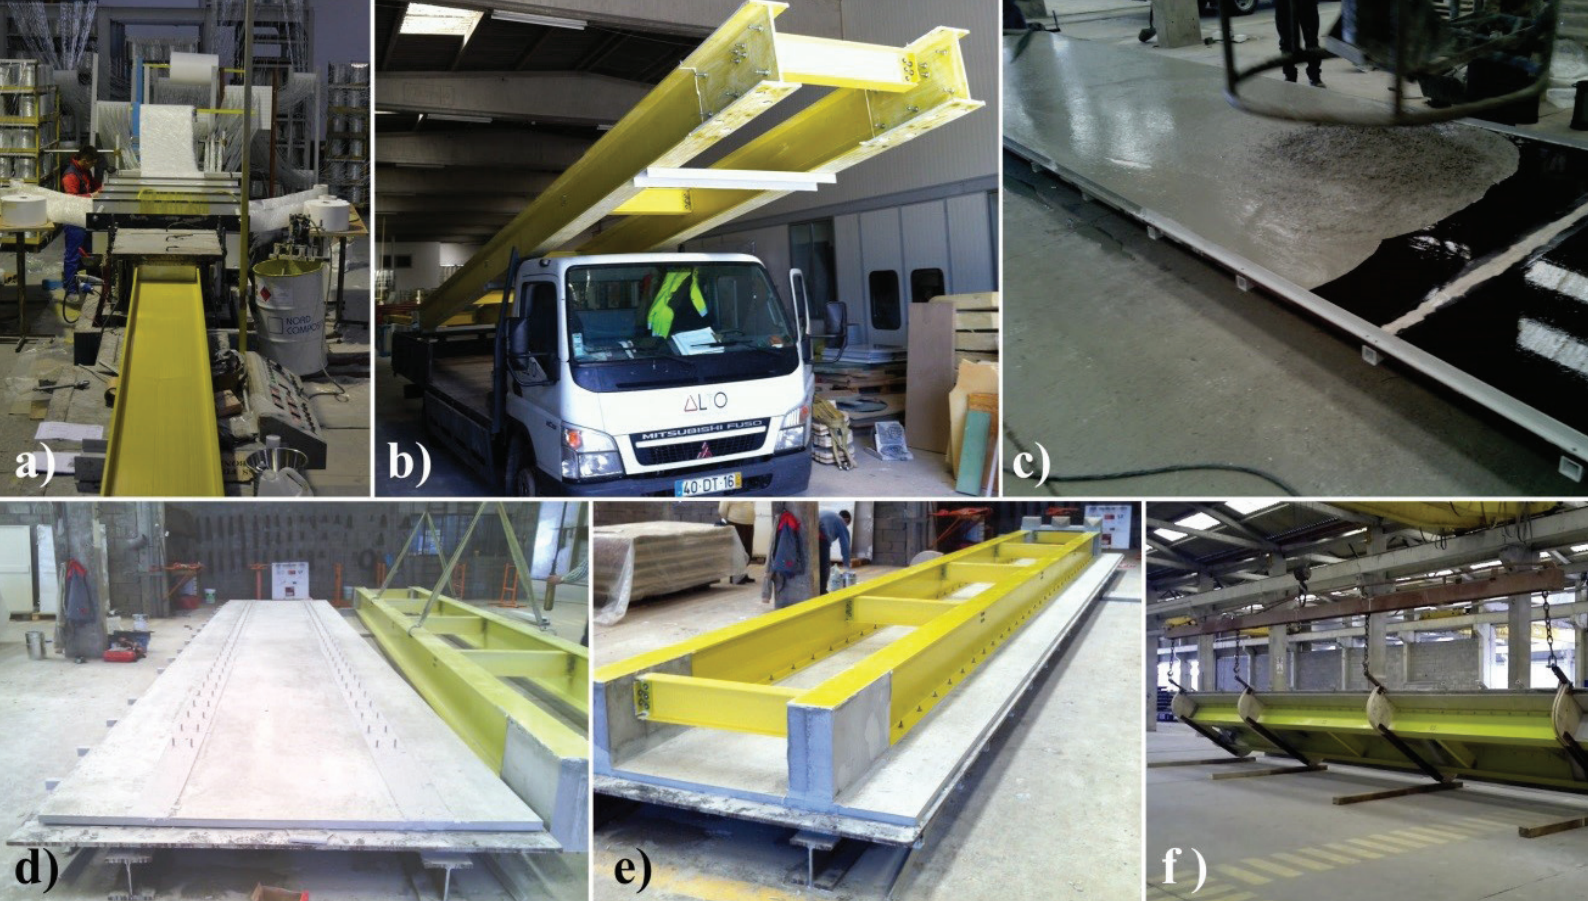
Construção do protótipo: a) pultrusão dos perfis de GFRP; b) transporte da subestrutura; c) betonagem do tabuleiro; d) instalação dos sistemas de conexão; e) montagem dos elementos em GFRP sobre o tabuleiro; f) posicionamento do protótipo.
